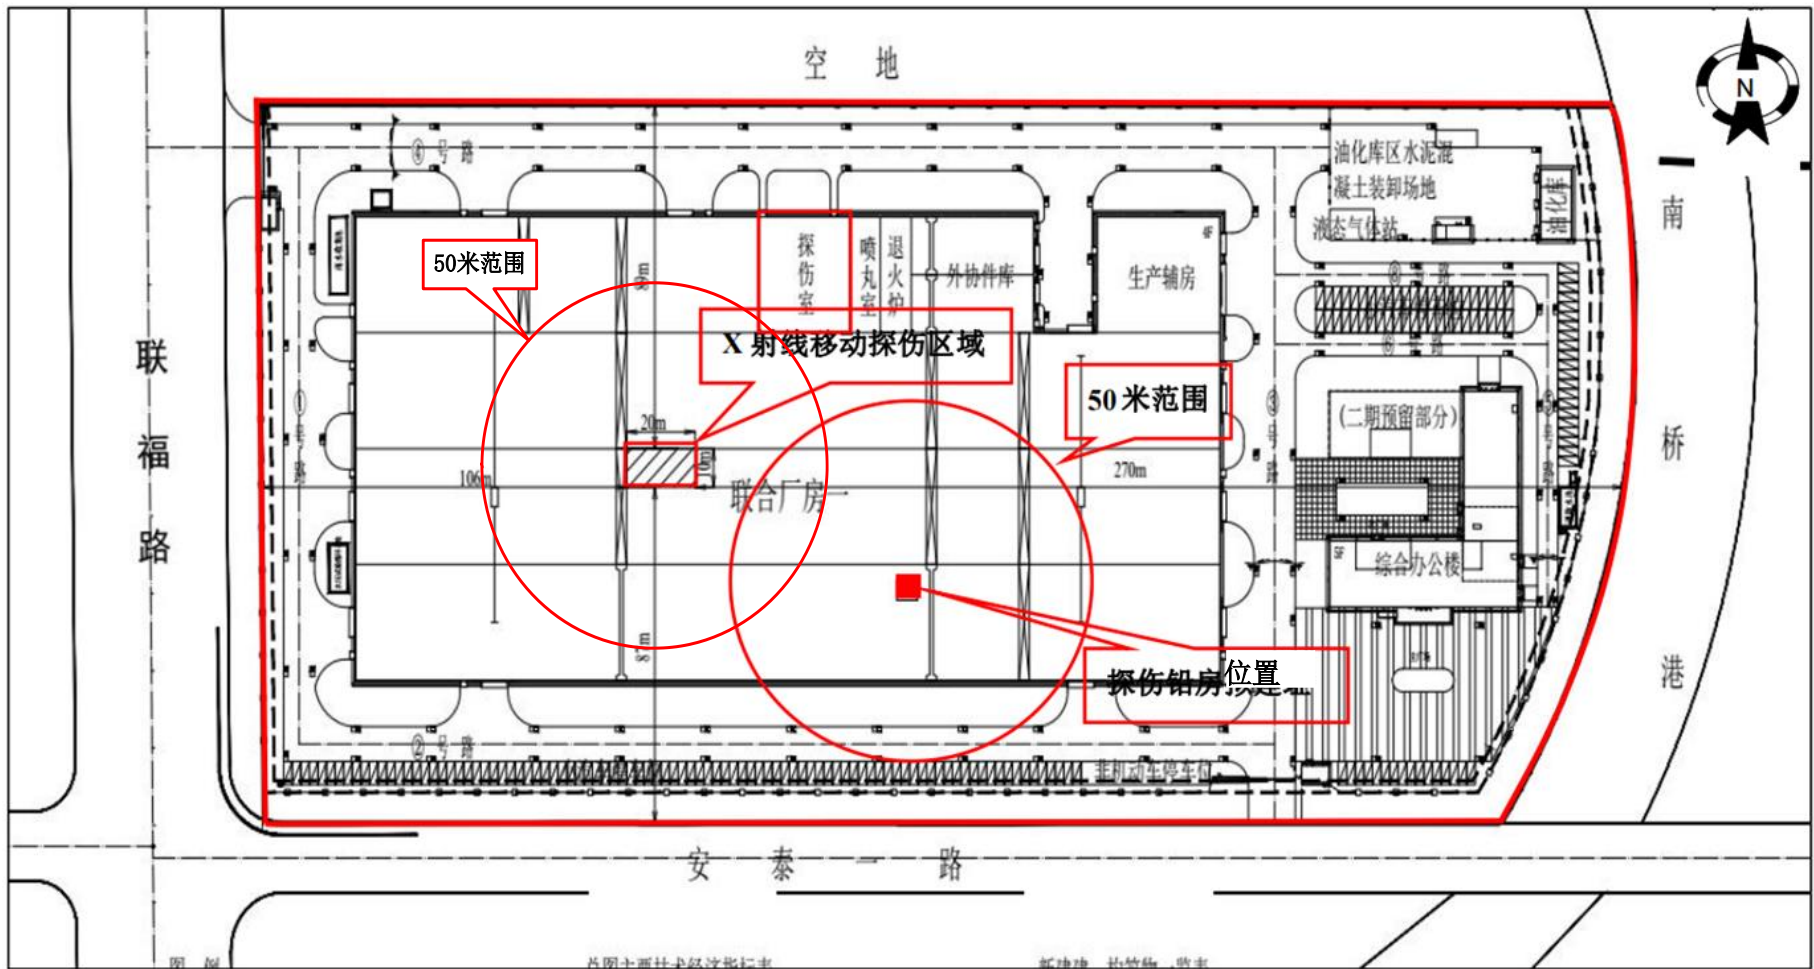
上海工业锅炉（无锡）有限公司平面布置图
